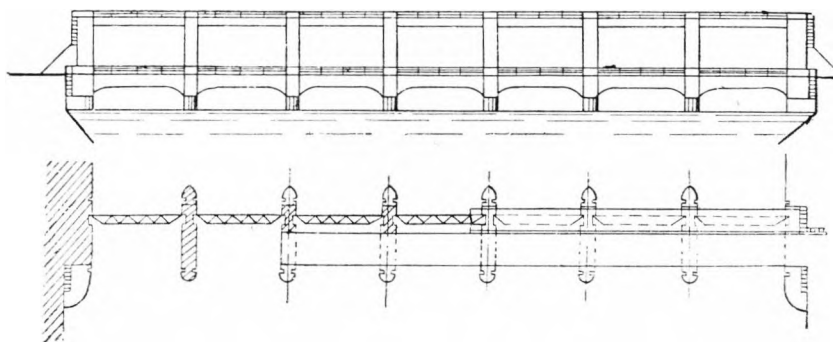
Схематический план и фасад плотины с щитовыми затворами.
